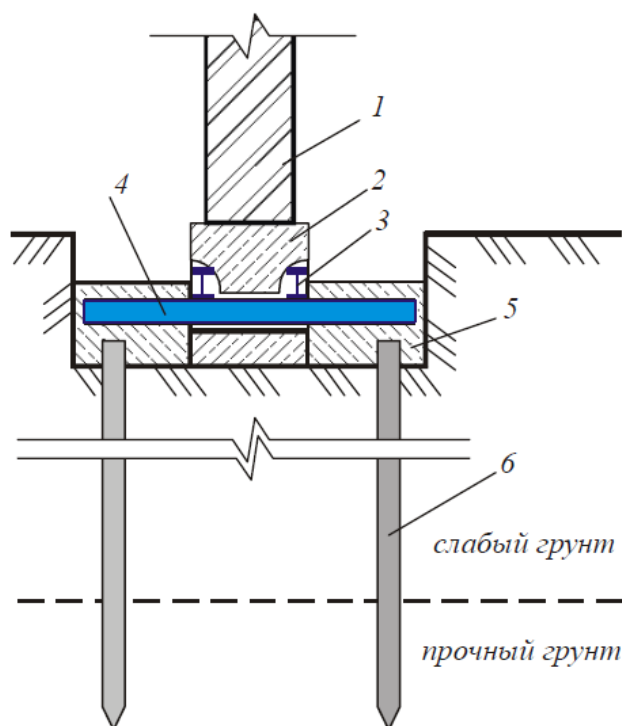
Усиление фундаментов с помощью выносных свай.
